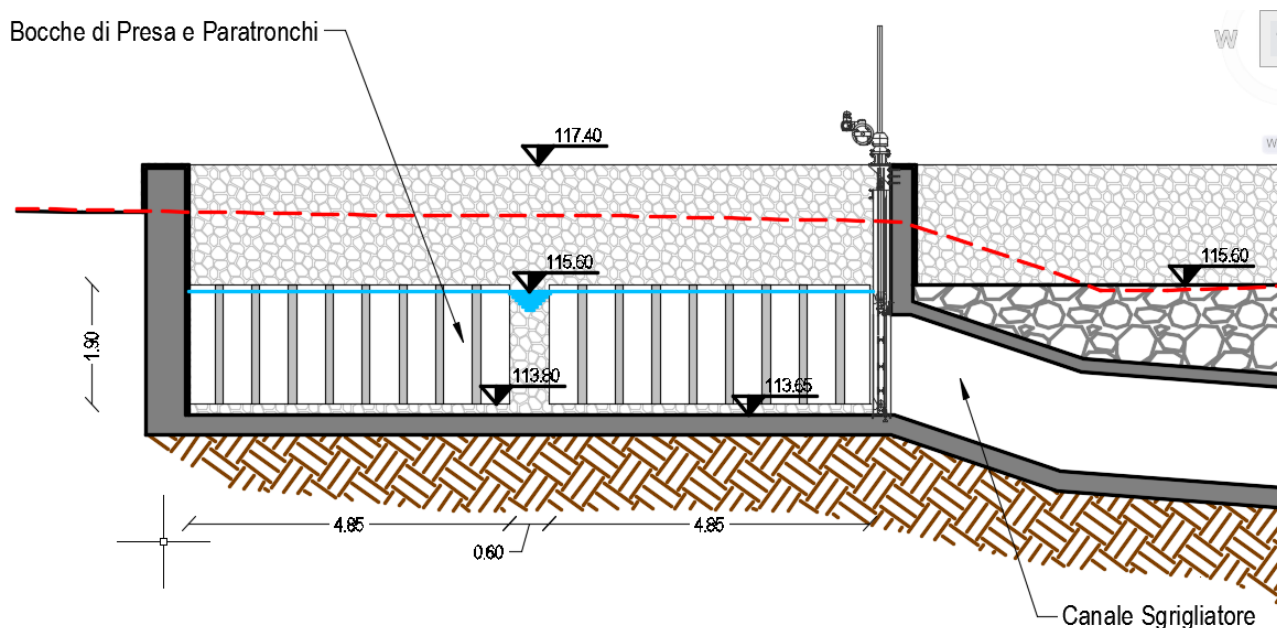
VISTA IN PROSPETTO DELL'OPERA DI PRESA
